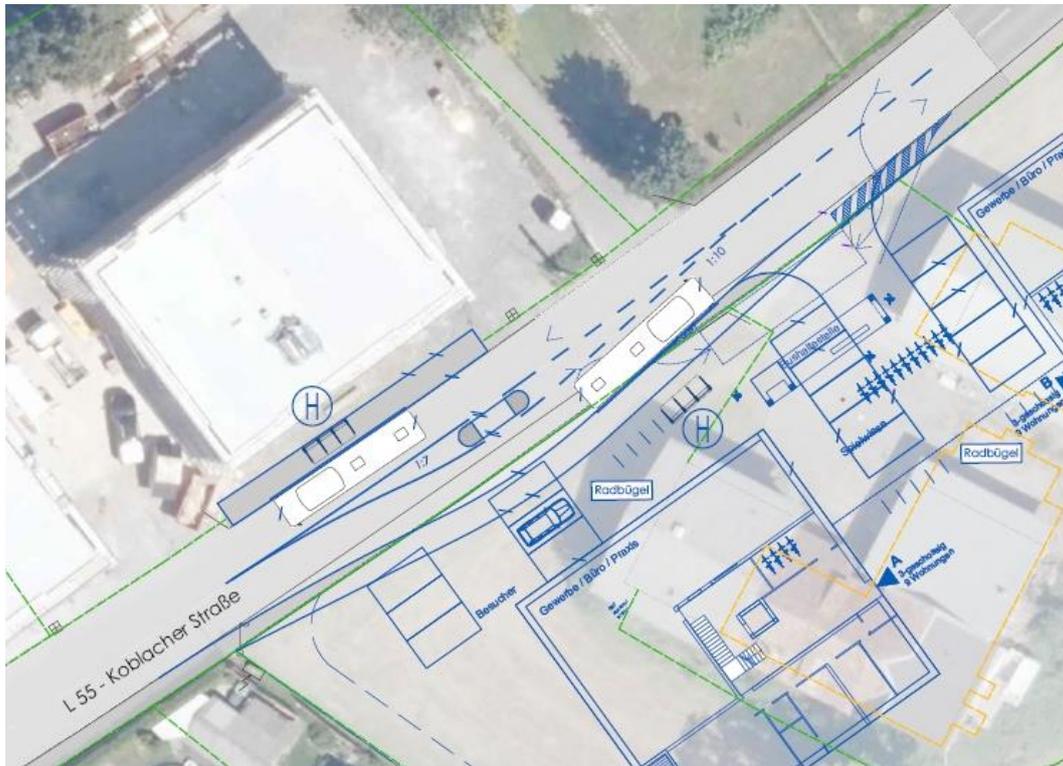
Planausschnitt Bushaltestelle und Querung L55 – Kutzen
